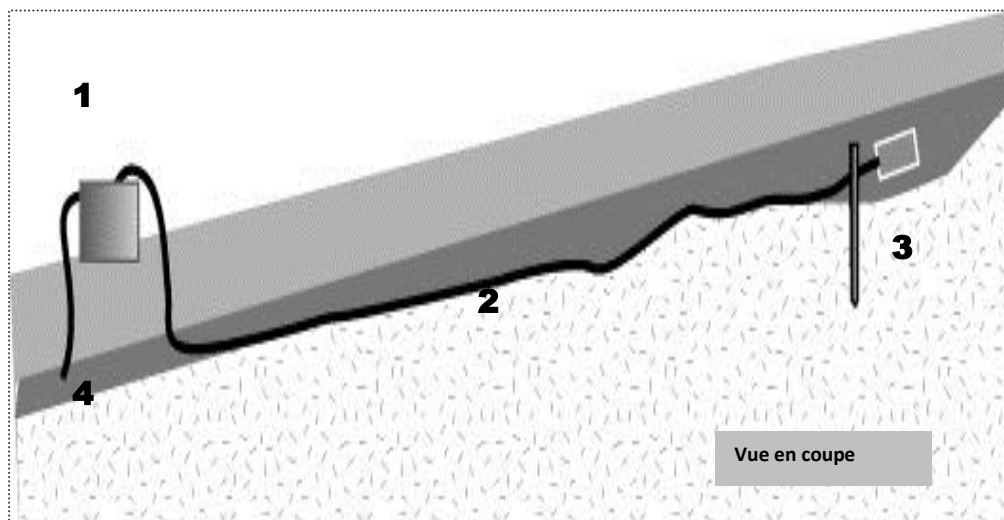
Plan en coupe d'un abreuvoir gravitaire
